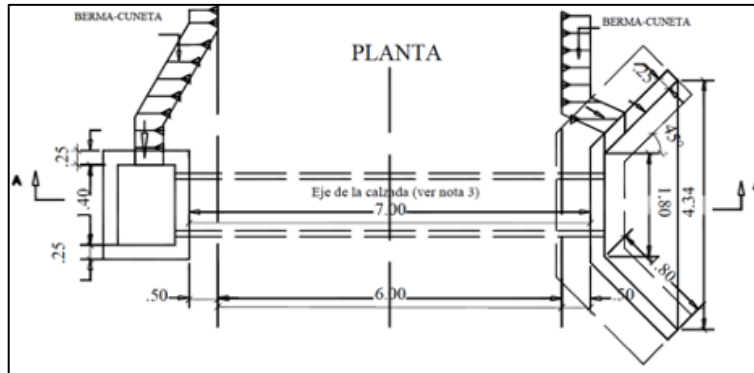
Planta de las estructuras hidráulicas a construir en el proyecto de Málaga-Santander
